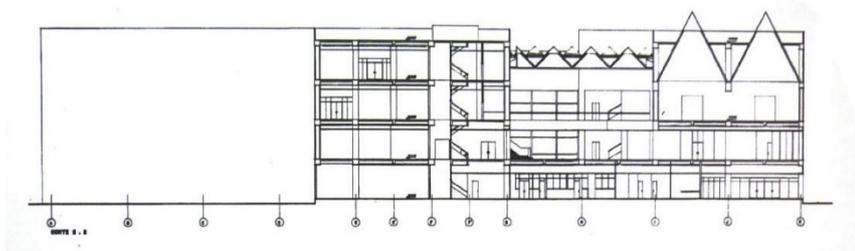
Planos originales y maqueta de proyecto Centro Cultural Entreríos
